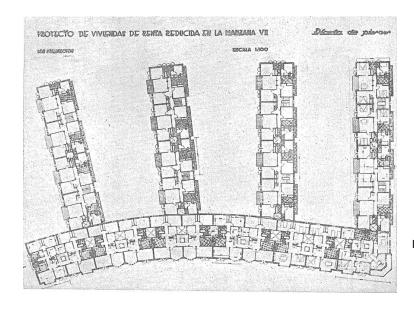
Viviendas de renta reducida entre las calles María Ángela y Bidebarrieta de Eibar (1941), con el norte situado en la parte inferior del plano. Todos los dormitorios tenían asegurada la orientación sureste.
